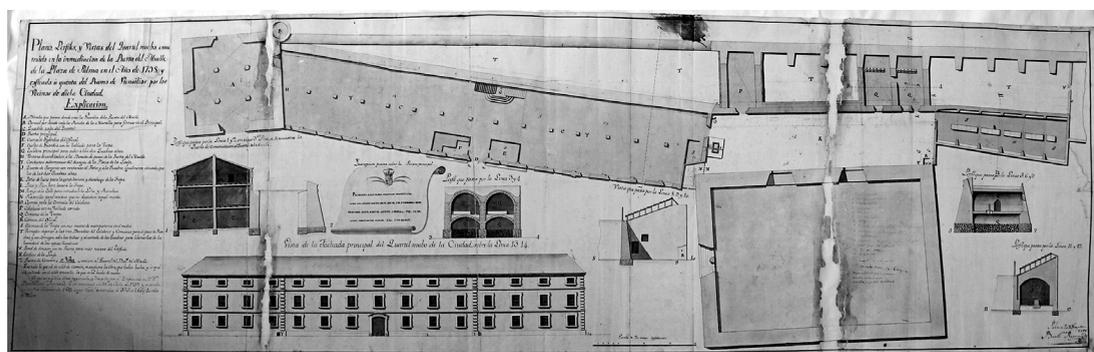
Plano del cuartel de la Lonja proyectado por Bartolomé Reynaud (1798).
